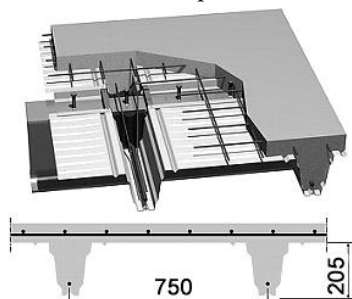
Монолитное перекрытие в несъемной металлической опалубке
